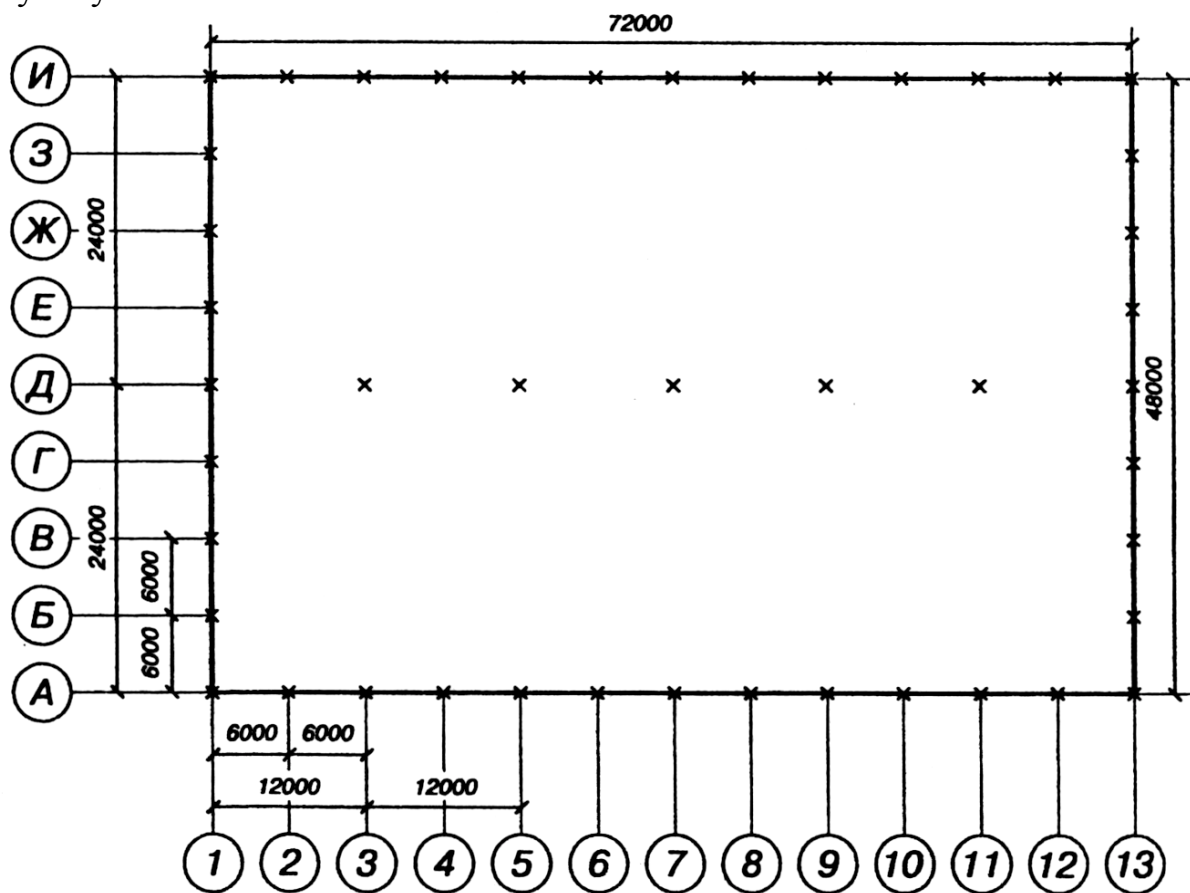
Нанесение размеров и координатной сетки на чертеже планировки производственного корпуса
